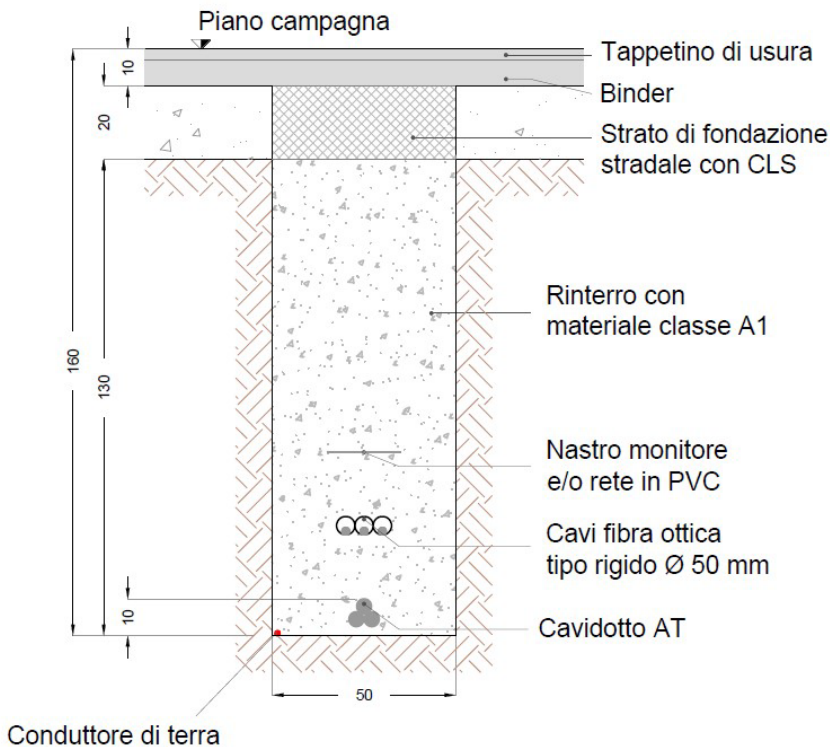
Sezione tipo cavidotto AT una terna su strada asfaltata
